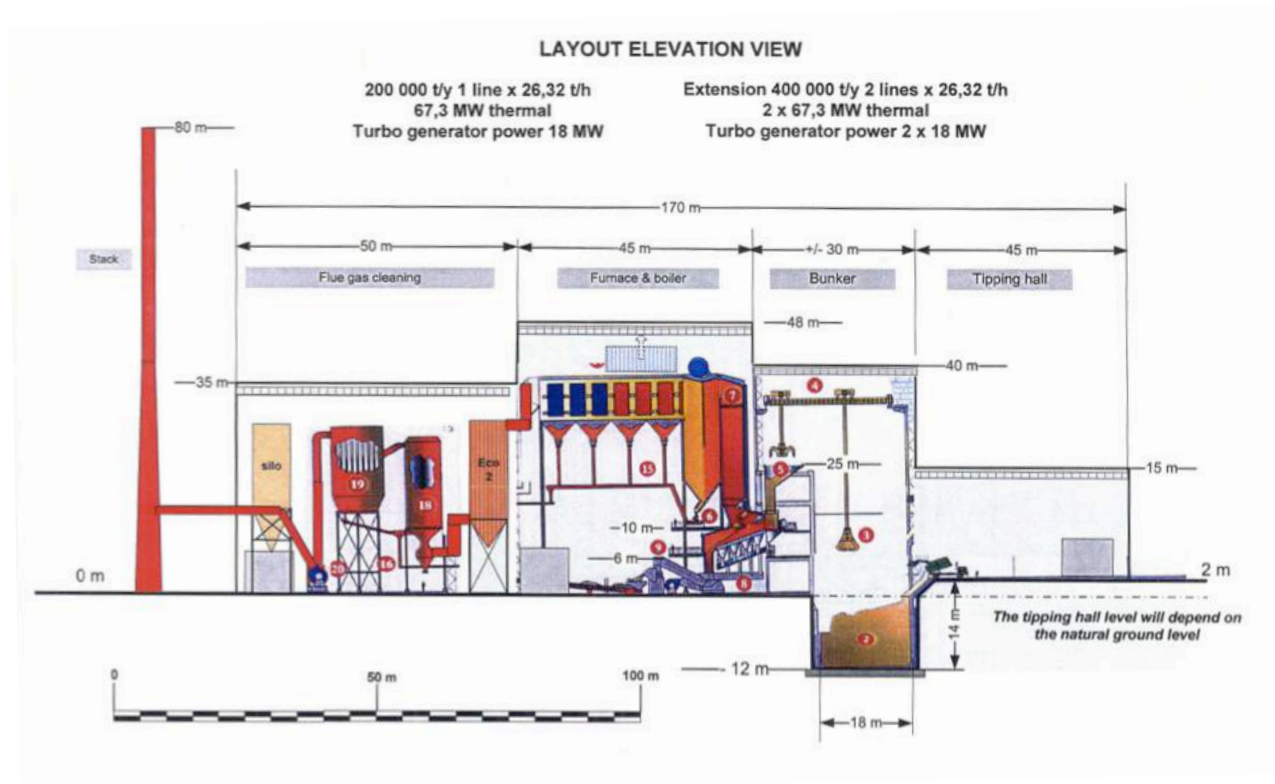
VISTA EN ALZADO DE UN DISEÑO PLANTA WTE DE PARRILLA DE COMBUSTIÓN (EEC)
